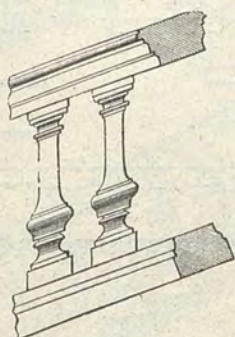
Parapetto dello scalone del Palazzo dell'Accademia Filarmonica a Torino.
